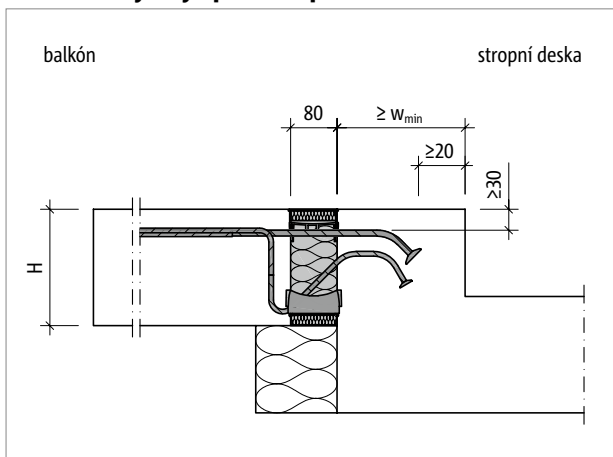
Schöck Isokorb® T typ KL-U/KL-O, T typ QL-VV: Balkón ve vnitřním rohu, podepřený ze dvou stran
